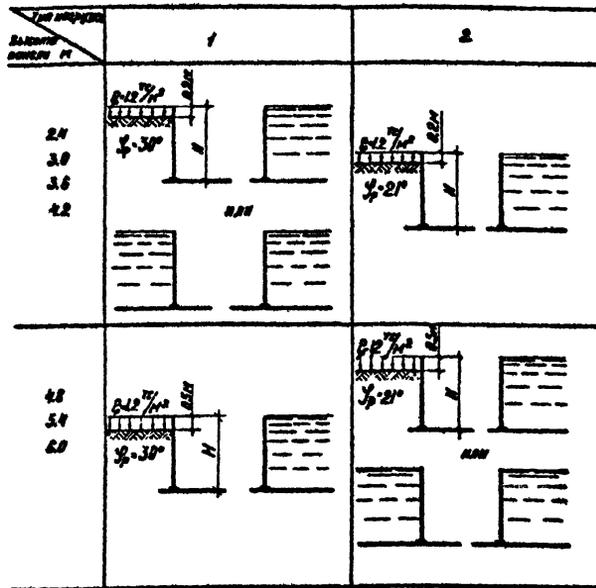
Схемы расчетных нагрузок на консольные и балочные стены открытых сооружений высотой 2,4 + 6,0 м
